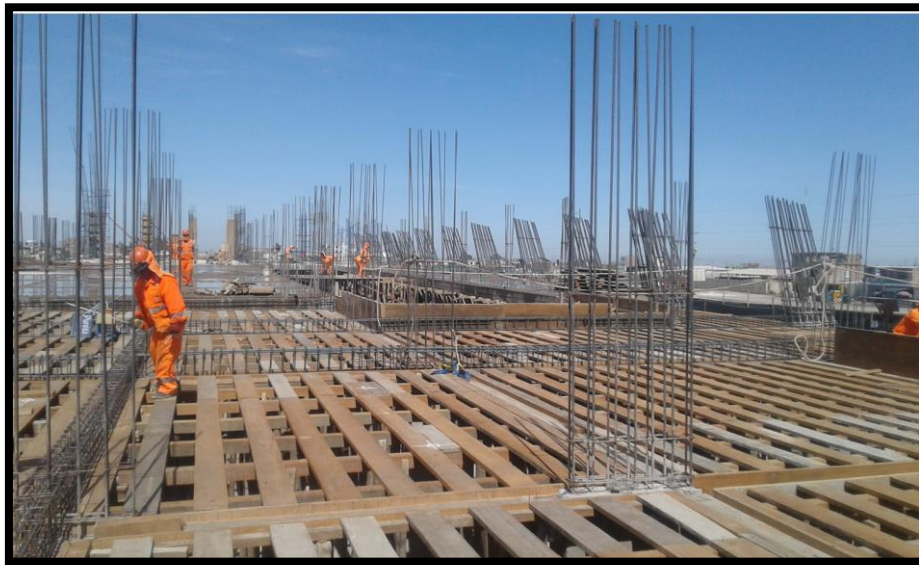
Colocación de armadura para vigas del primer nivel, y encofrado para aligerado.
